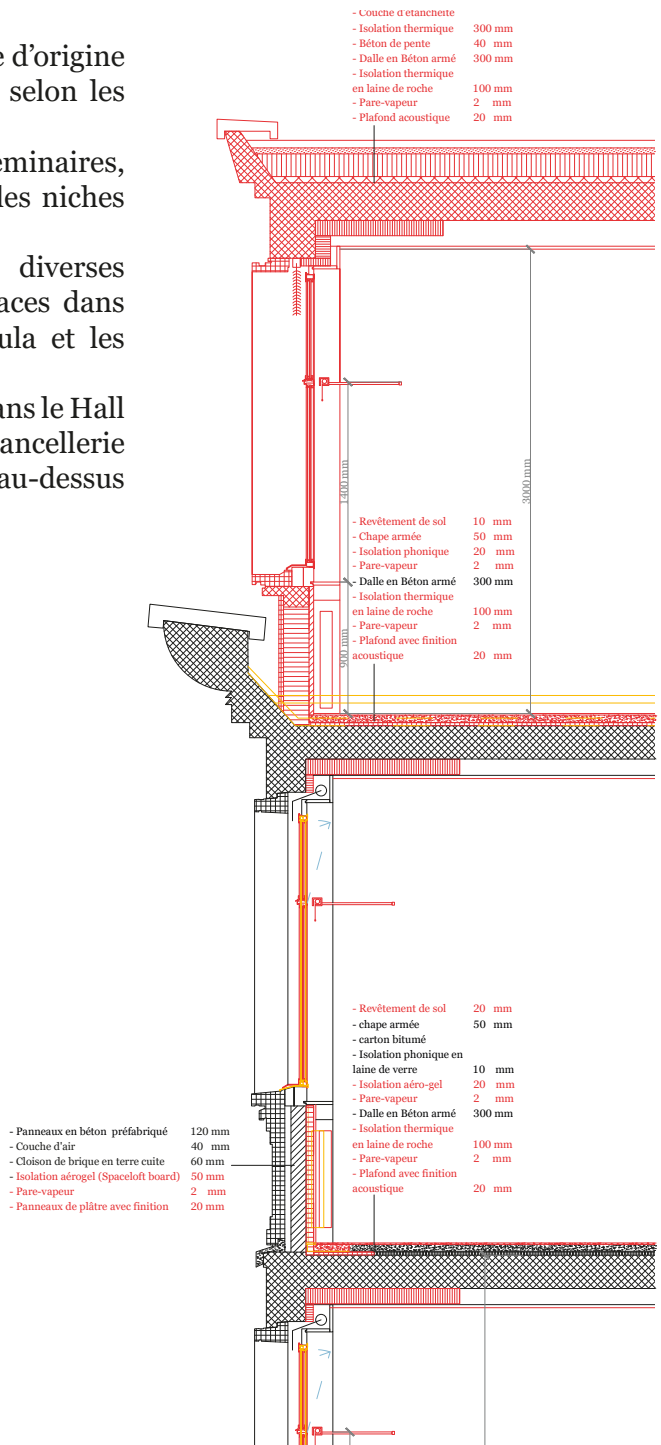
Coupe constructive du bâtiment de Cours et surélévation 1:50
